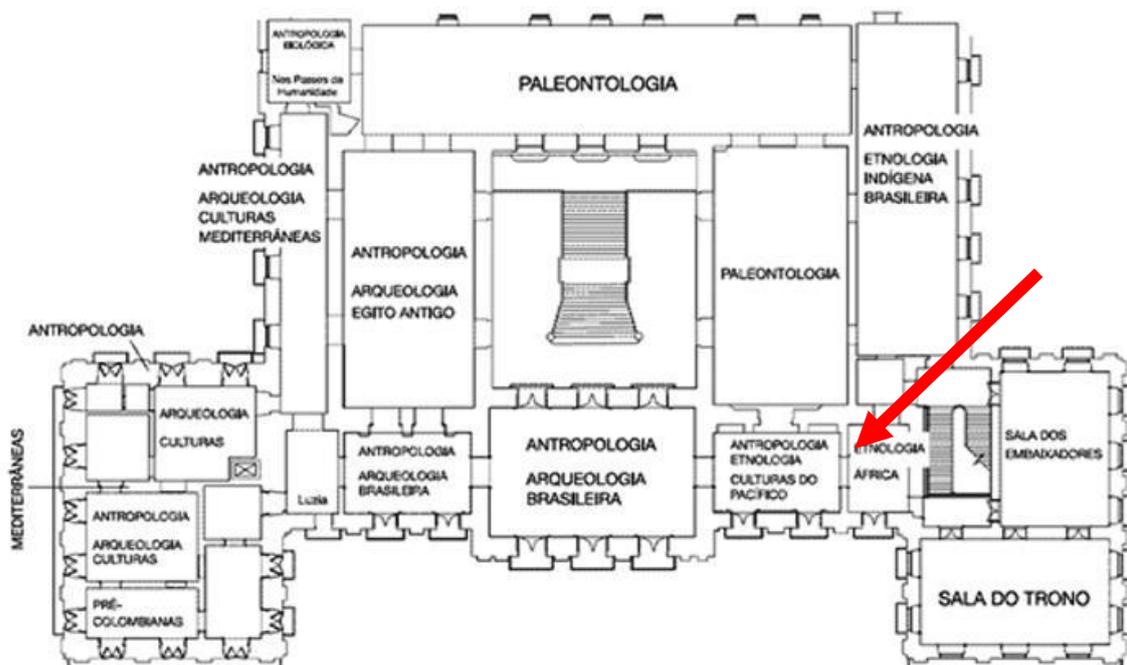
Marcação, na planta do segundo pavimento, da localização da mísula escolhida.
